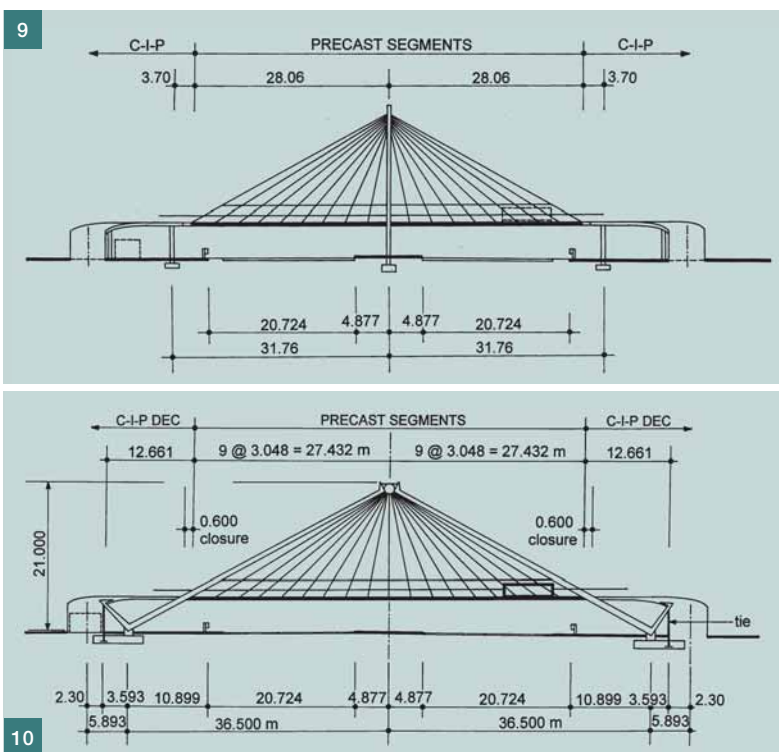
Lávka I-5, alternativa, podélný řez ■ Fig. 10 I-5 Bridge, alternative, elevation
